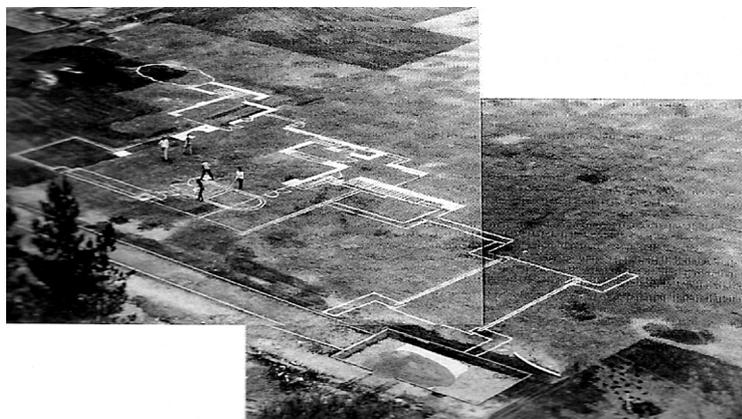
Planta Casa de la Cascada. Fuente: Revista ARQ, 44, p. 21. © Autores del trazado
